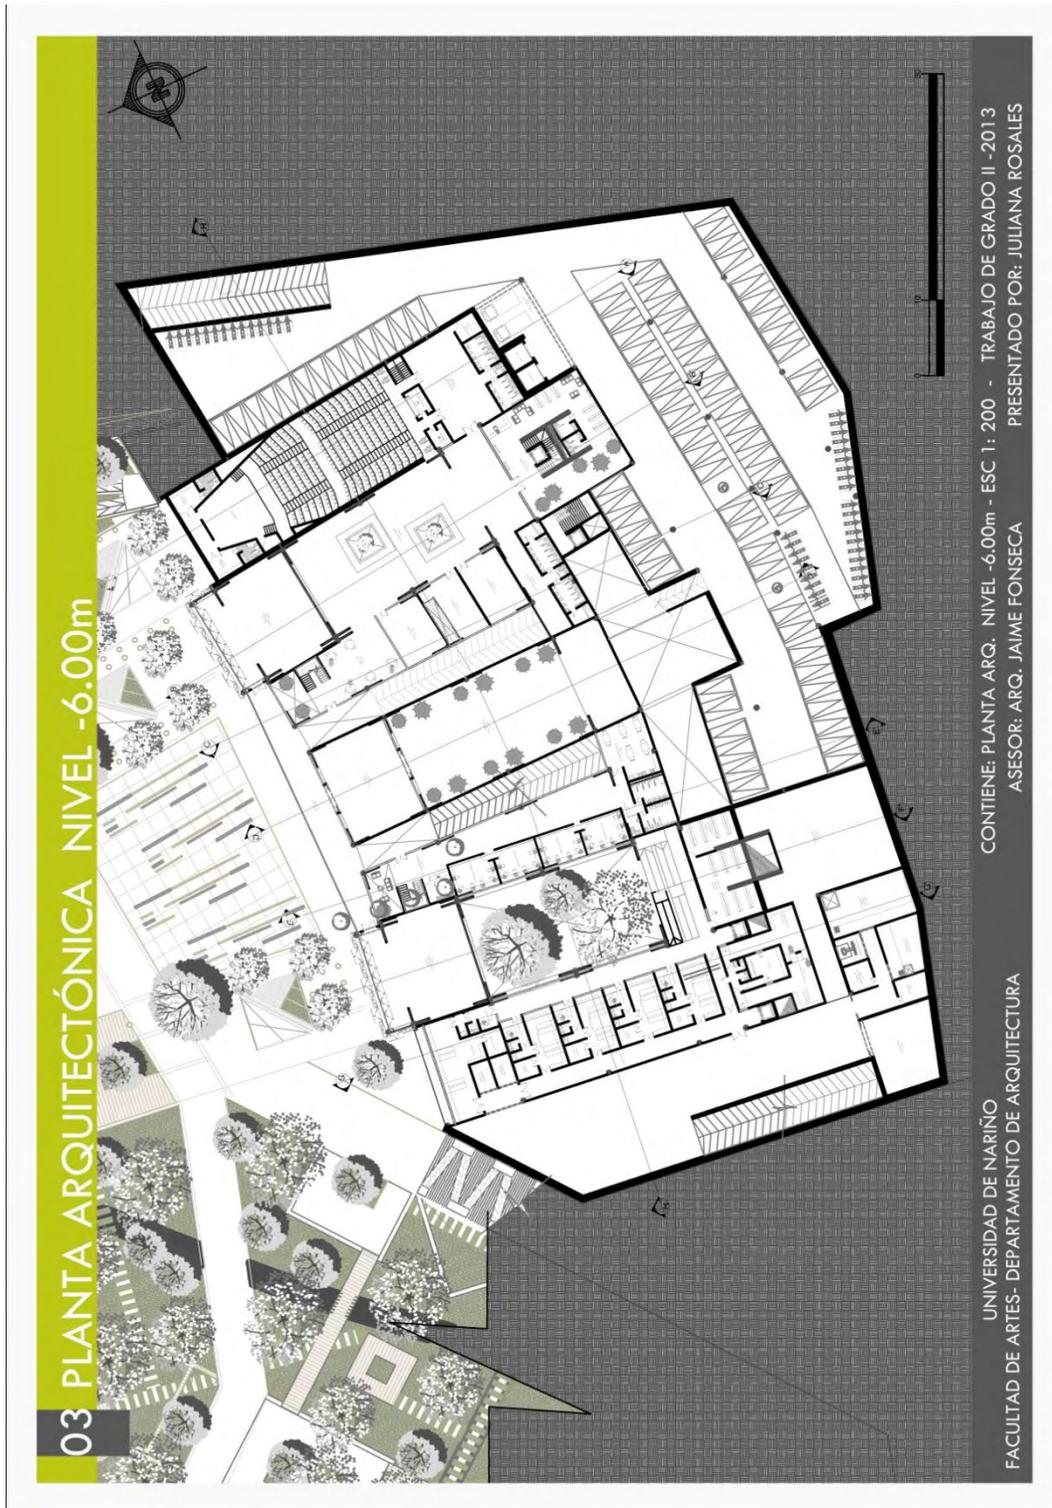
Proyecto_ Planta nivel -6.00m // Fuente esta investigación
